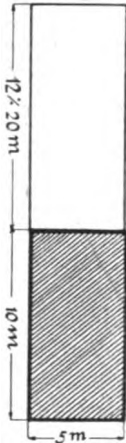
Haus in geschlossener Bauweise (schematisch).
